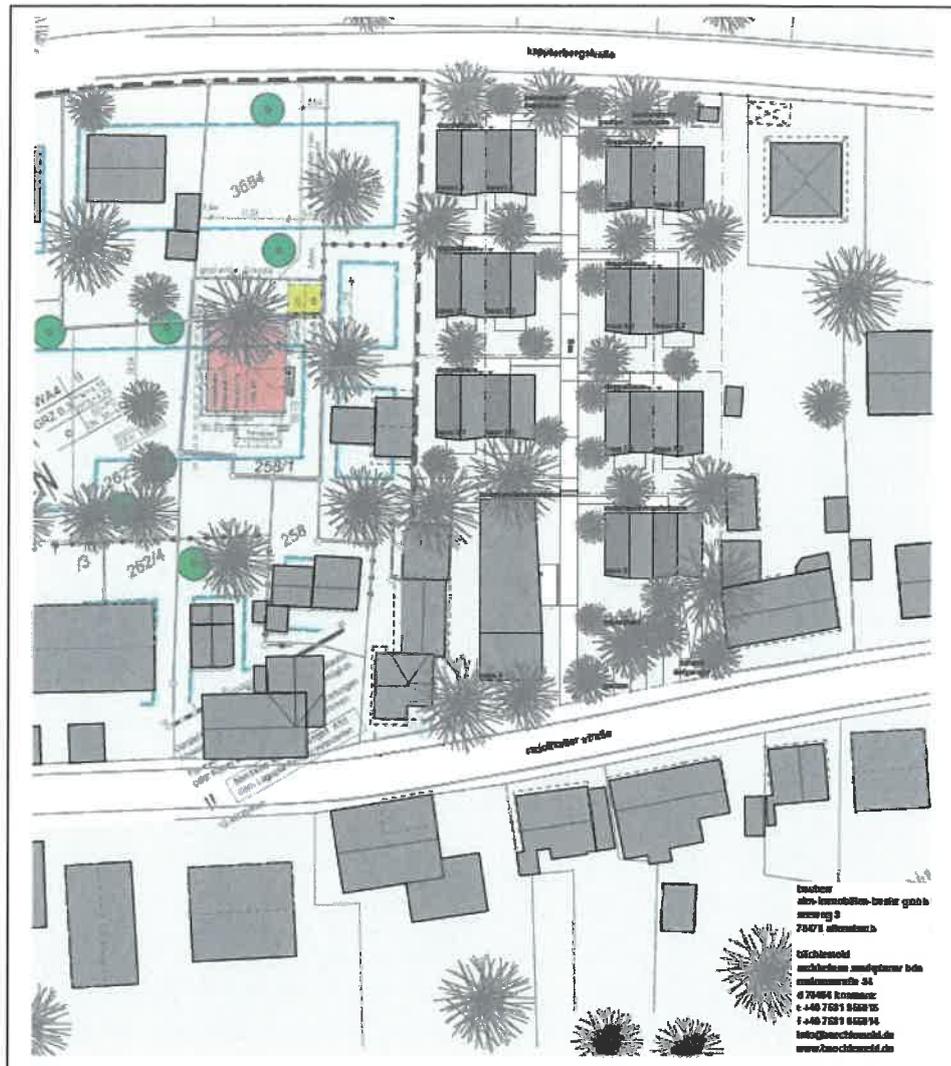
Lageplan zum Bebauungsplanentwurf „Broziat-Gelände“
